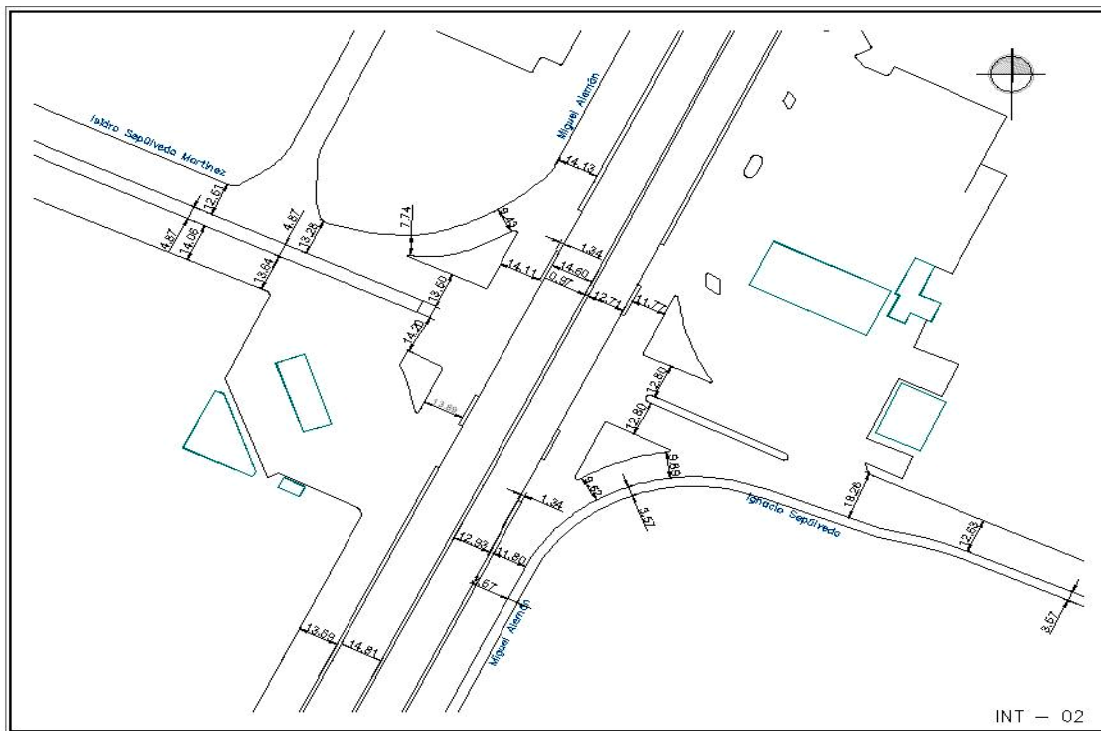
Levantamiento de planimetría en intersecciones. (Fuente: F.O.A., S.C., 2011)
